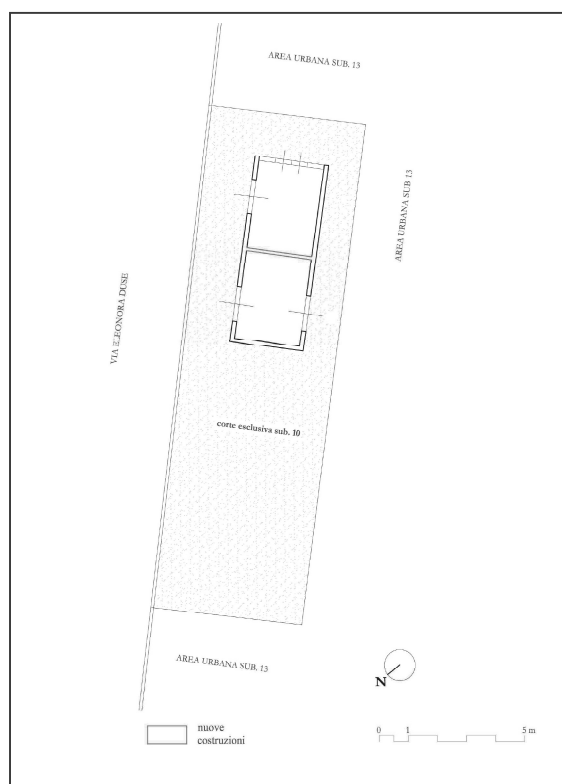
Cabina elettrica sub. 10. Stato di fatto. In rosso è indicata l'ipotetica suddivisione interna non riportata in planimetria
